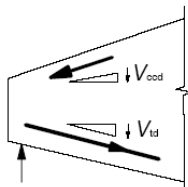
Querkraftkomponente für Bauteile mit geneigten Gurten
